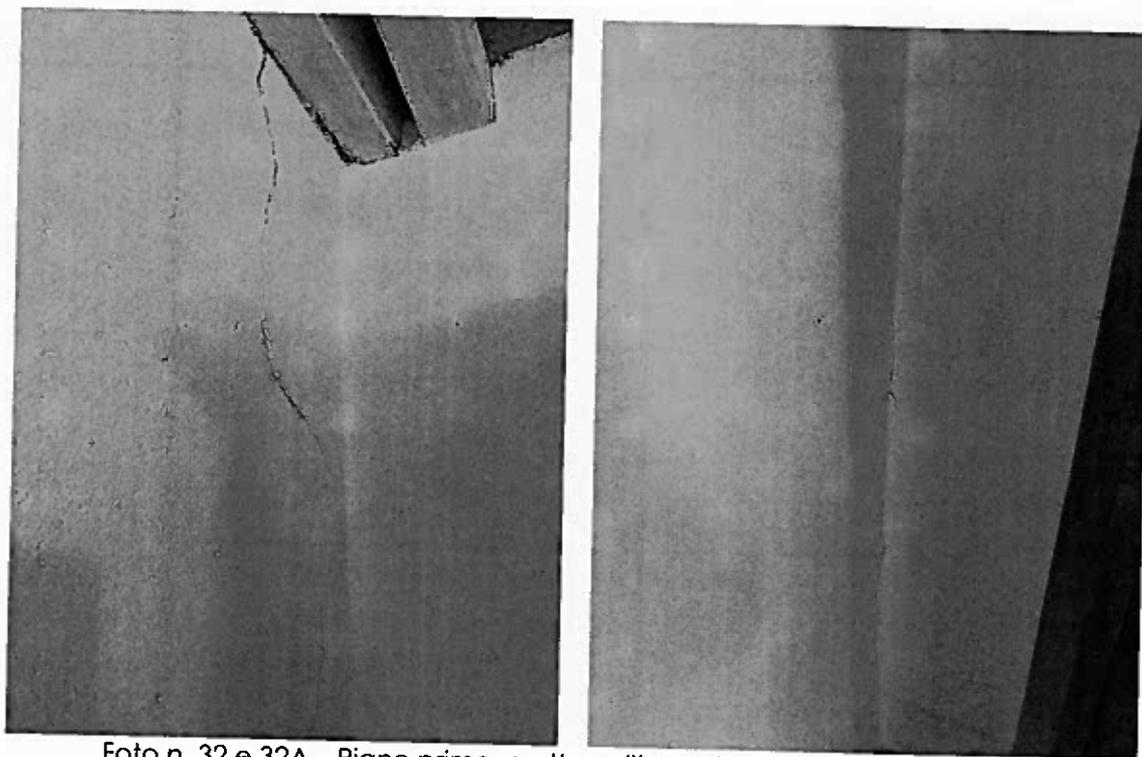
e 32A – Piano primo, cretto nell'angolo della camera con w.c.
